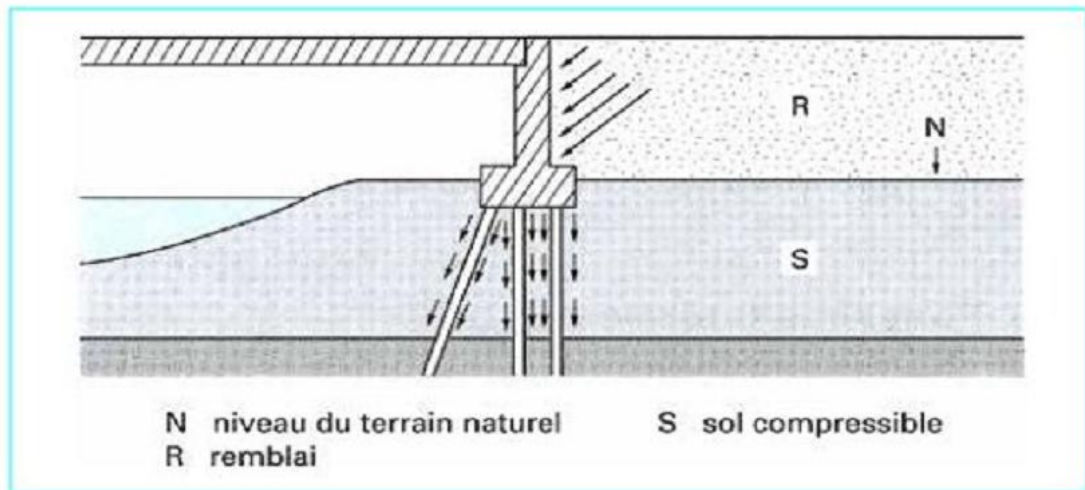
Poussées latérales sur les pieux d'une culée remblayée [18].
